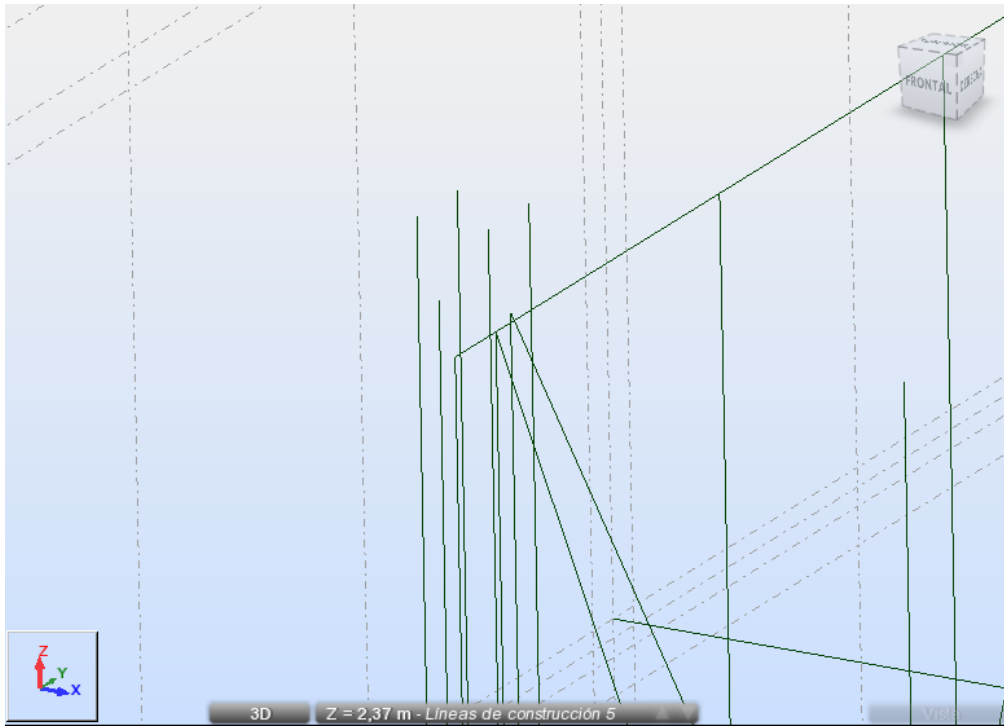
Vista alámbrica de la conexión tipo primera planta.
